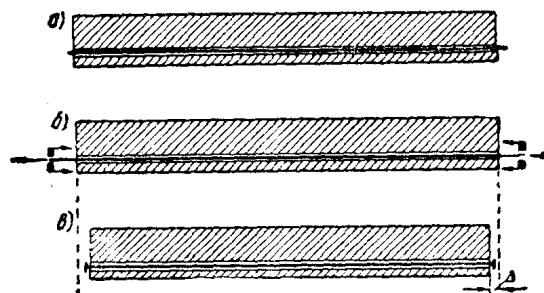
梁澆筑混凝土后，鋼筋与混凝土产生預施应力的情形
